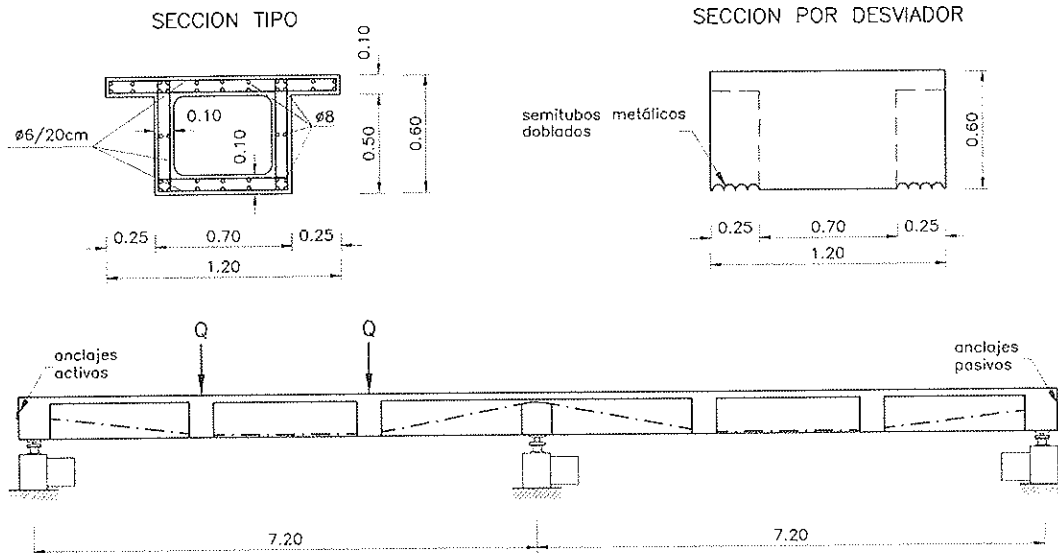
Secciones tipo y alzado lateral de la viga ensayada. Pretensado VCPAS.
